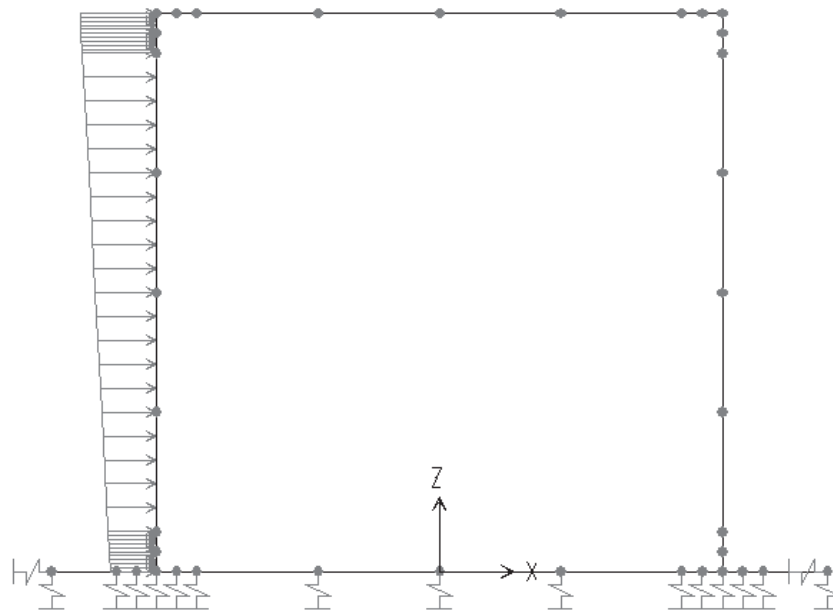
SPINTA DOVUTA DALL’AZIONE VERTICALE DA TRAFFICO SUL PIEDR. SX SQMS
